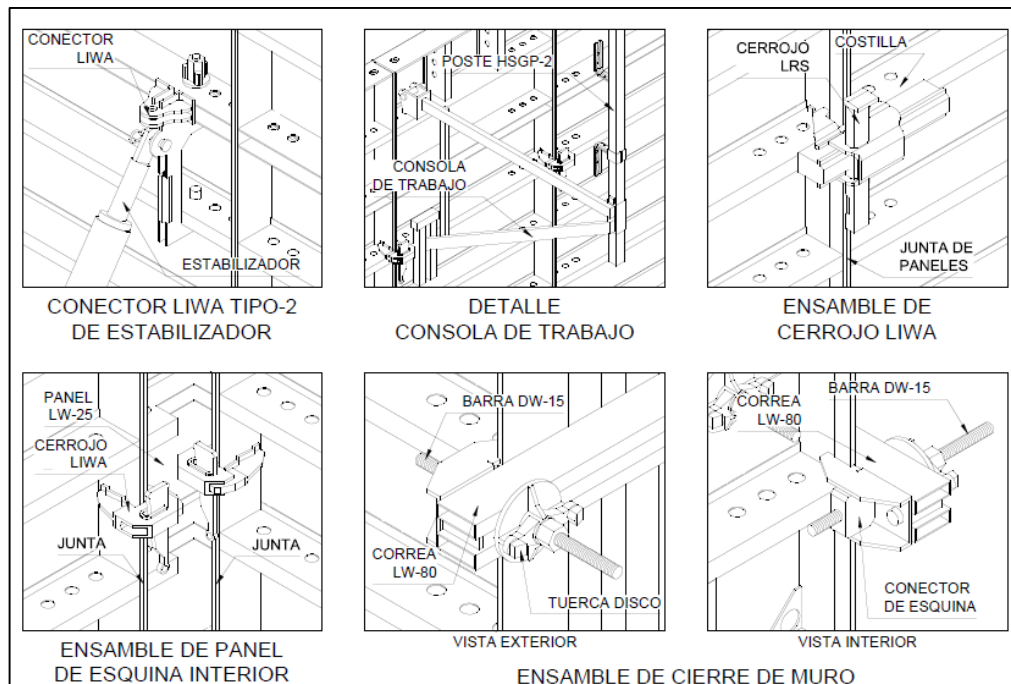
Detalles de seguros en encofrado modulado de muros en cisternas.
